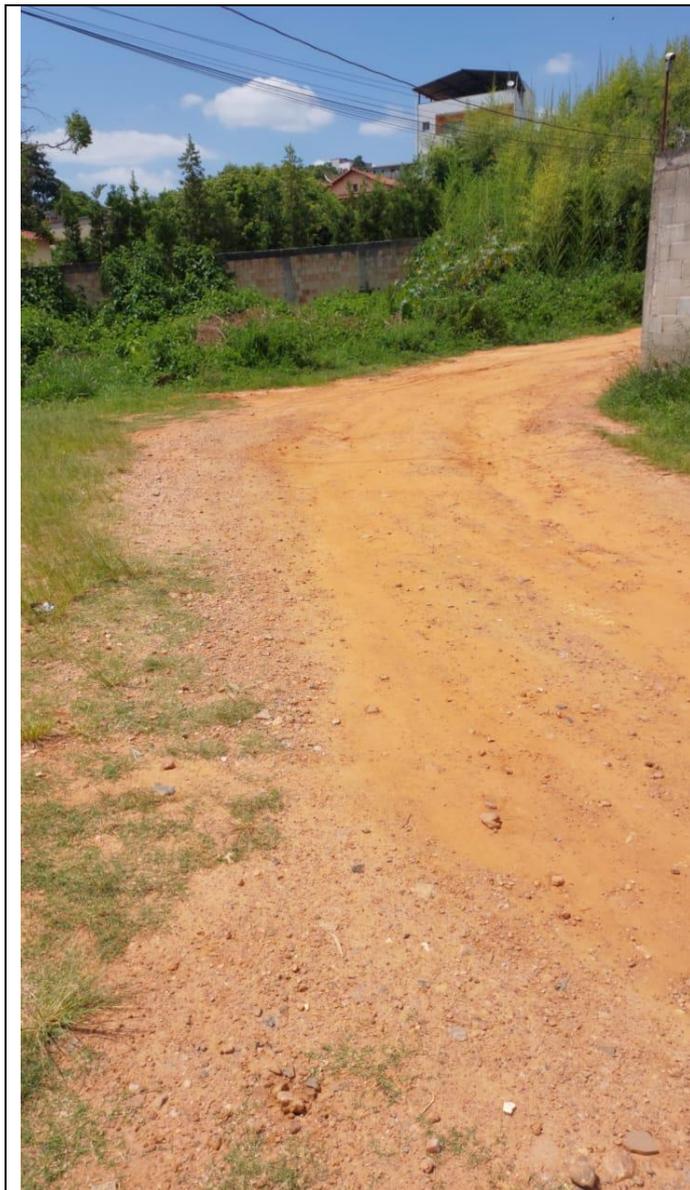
Rua Benjamin Paulo Curi – Bairro Grogotó.
